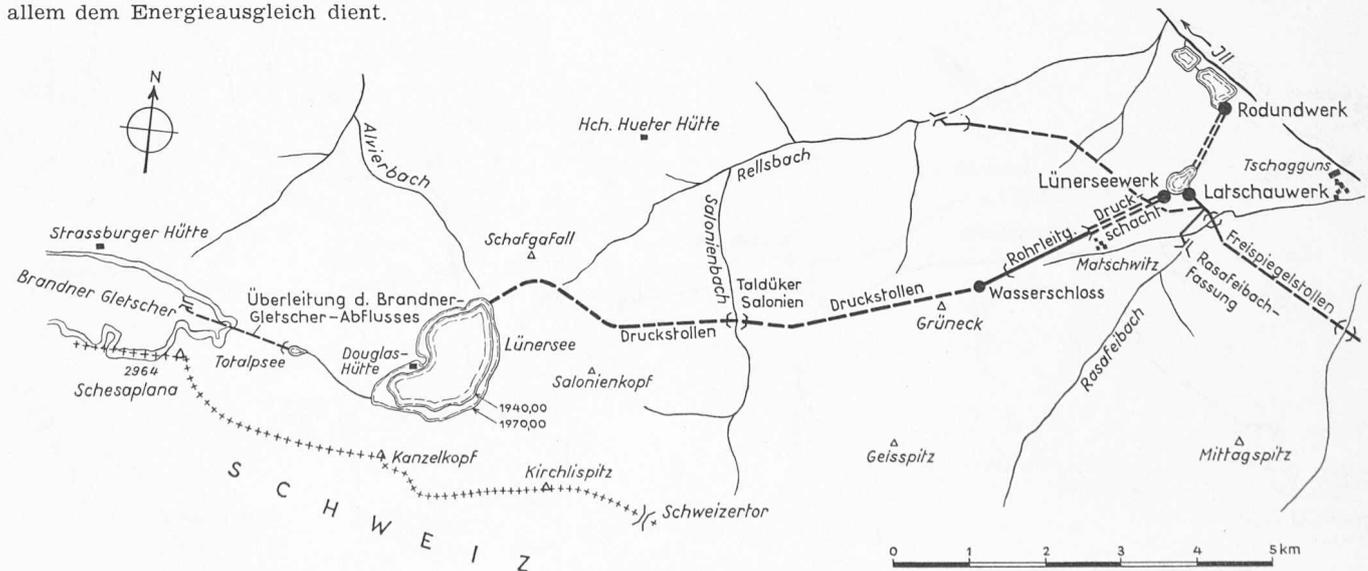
Lageplan des Lünerseewerks, 1:100 000
